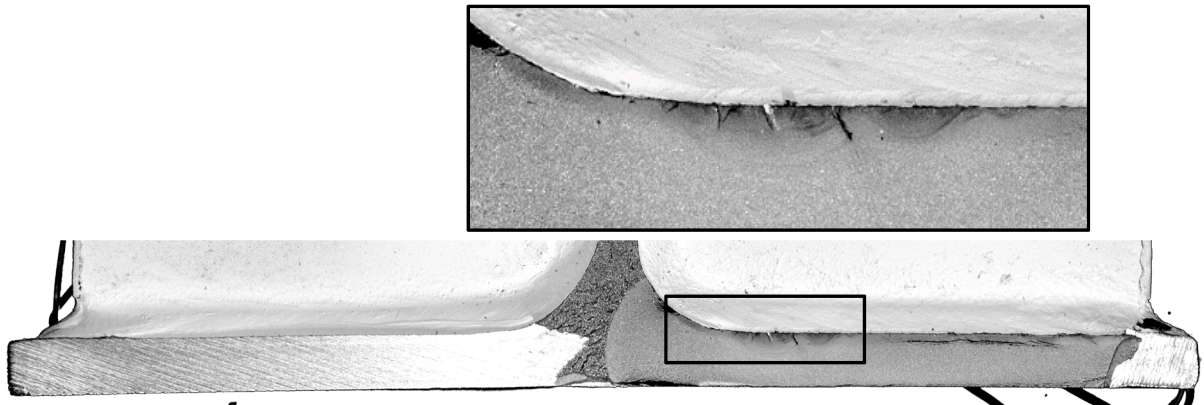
Bruchbild Versuchsträger T2.4 AW - Detailansicht
